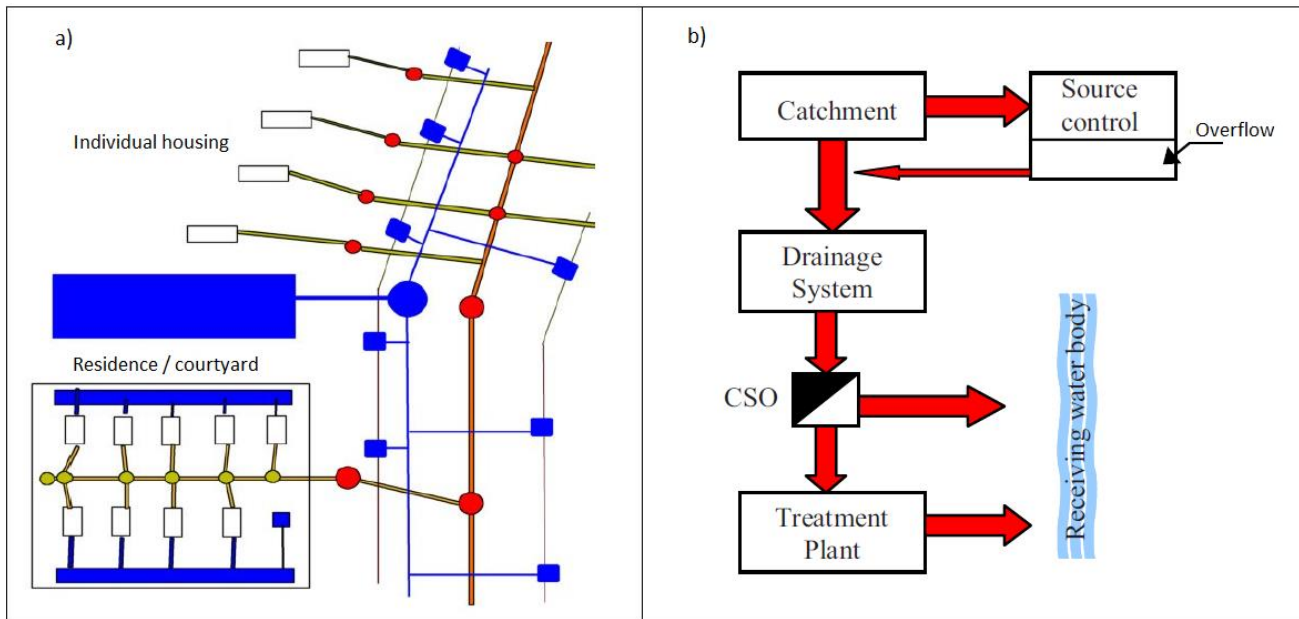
a) Sistema alternativo de drenaje urbano – manejo en la fuente (Fuente: [42]), b) sistema alternativo de drenaje urbano - manejo en la fuente, combinado con sistema centralizado de almacenamiento (Fuente: [45])
